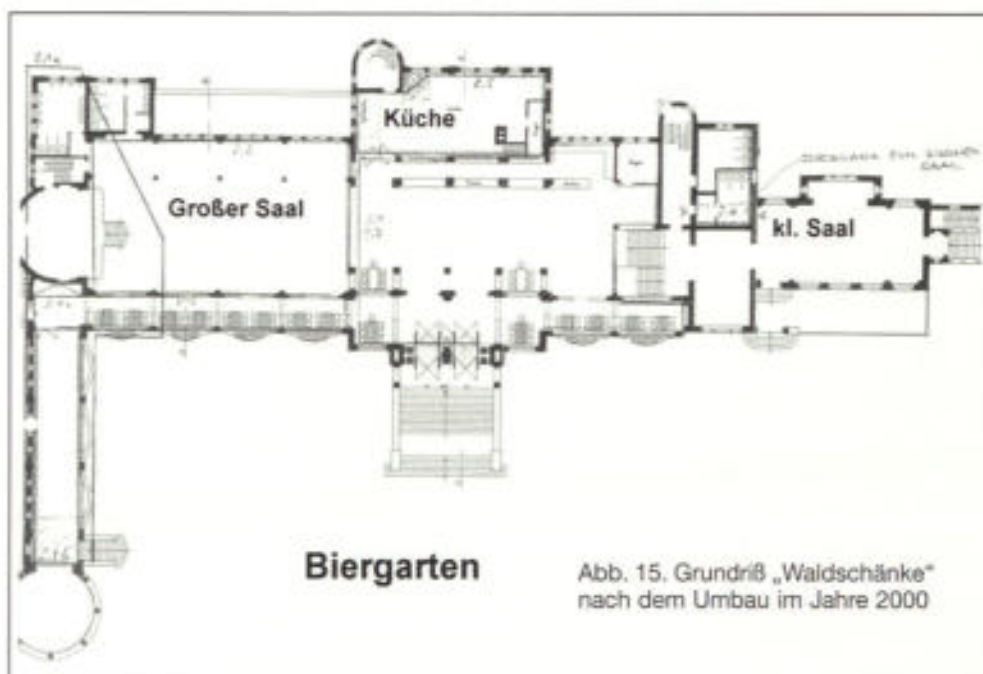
Grundriß „Waldschänke“ nach dem Umbau im Jahre 2000
